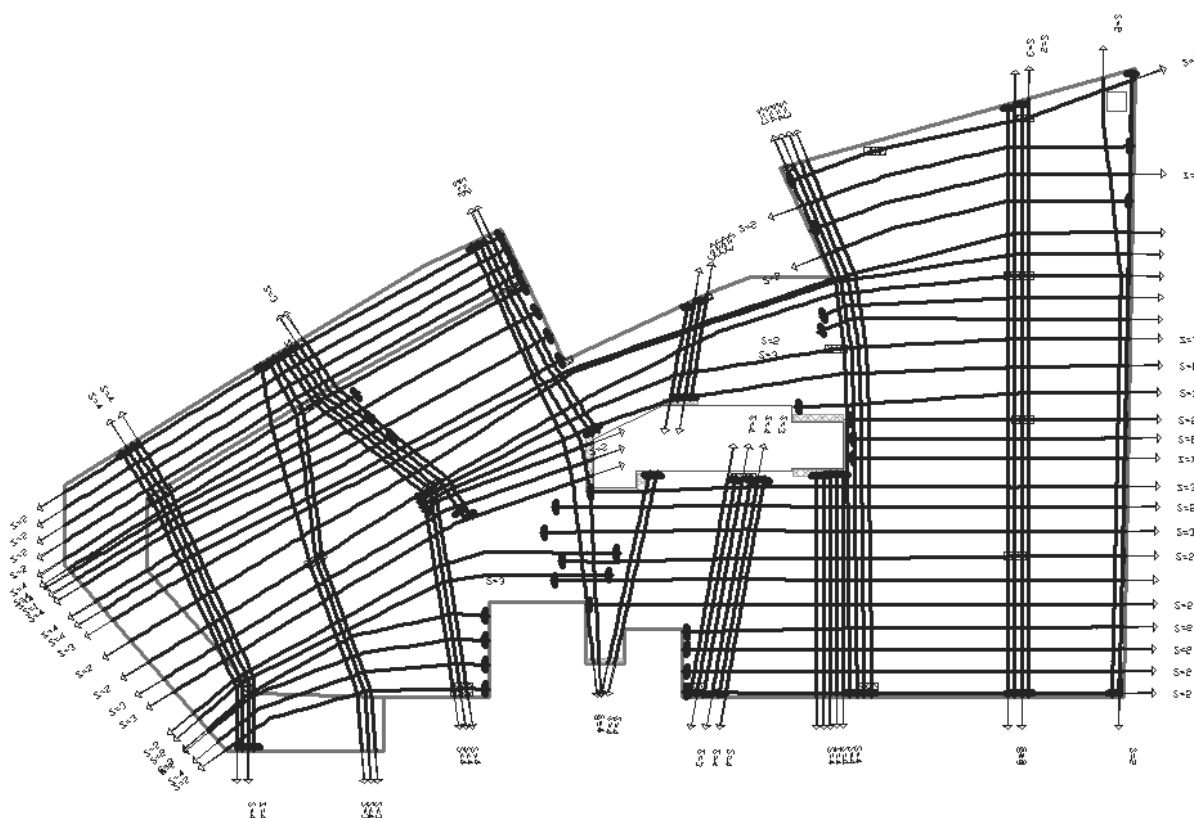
Traçado dos cabos (FLOOR-PRO)
